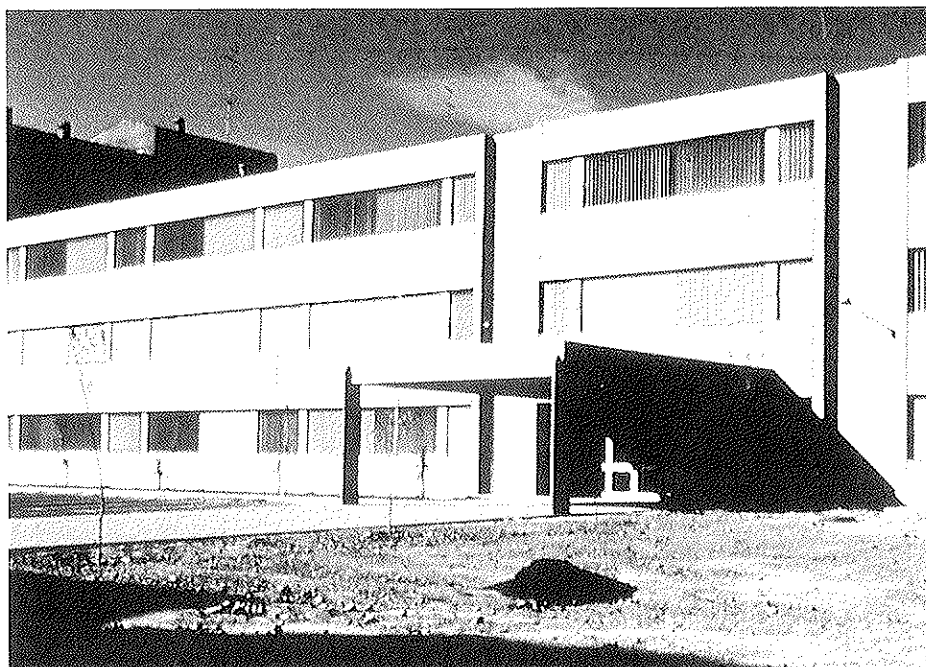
Edificio con piezas en H, prefabricado por PACADAR.
